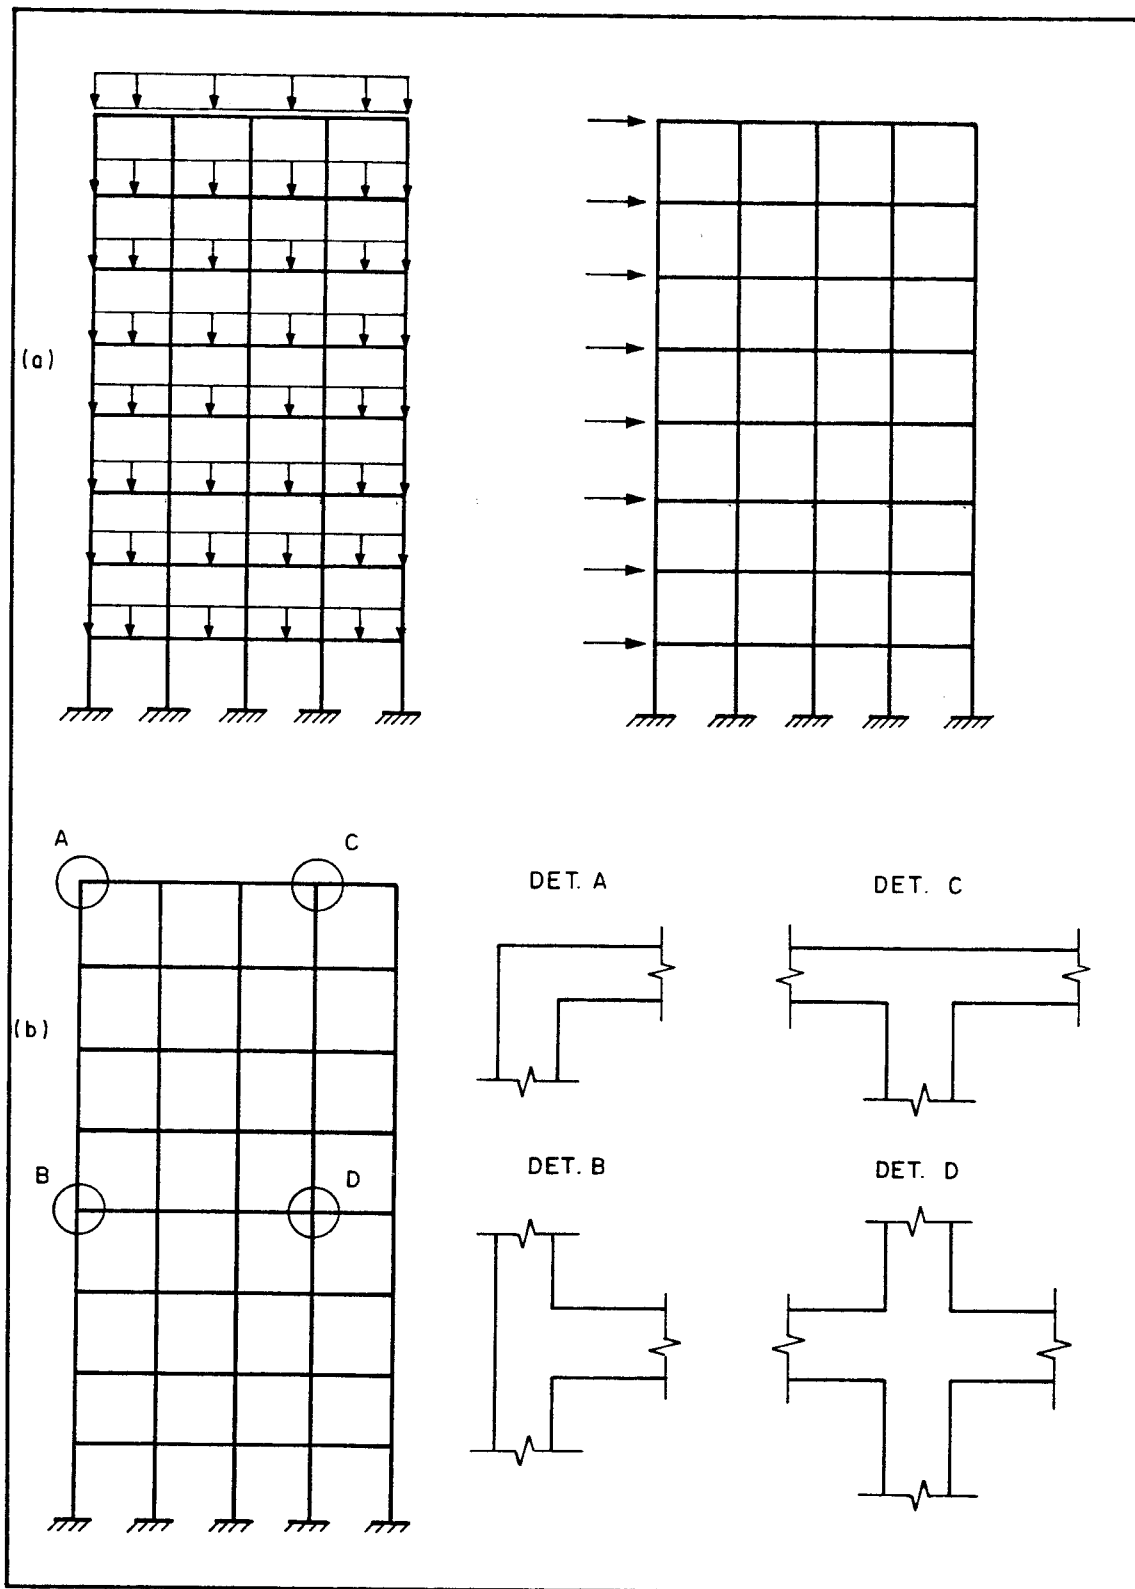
Pórtico de concreto armado em edifícios altos : a) ações verticais e horizontais, b) detalhes das ligações.
